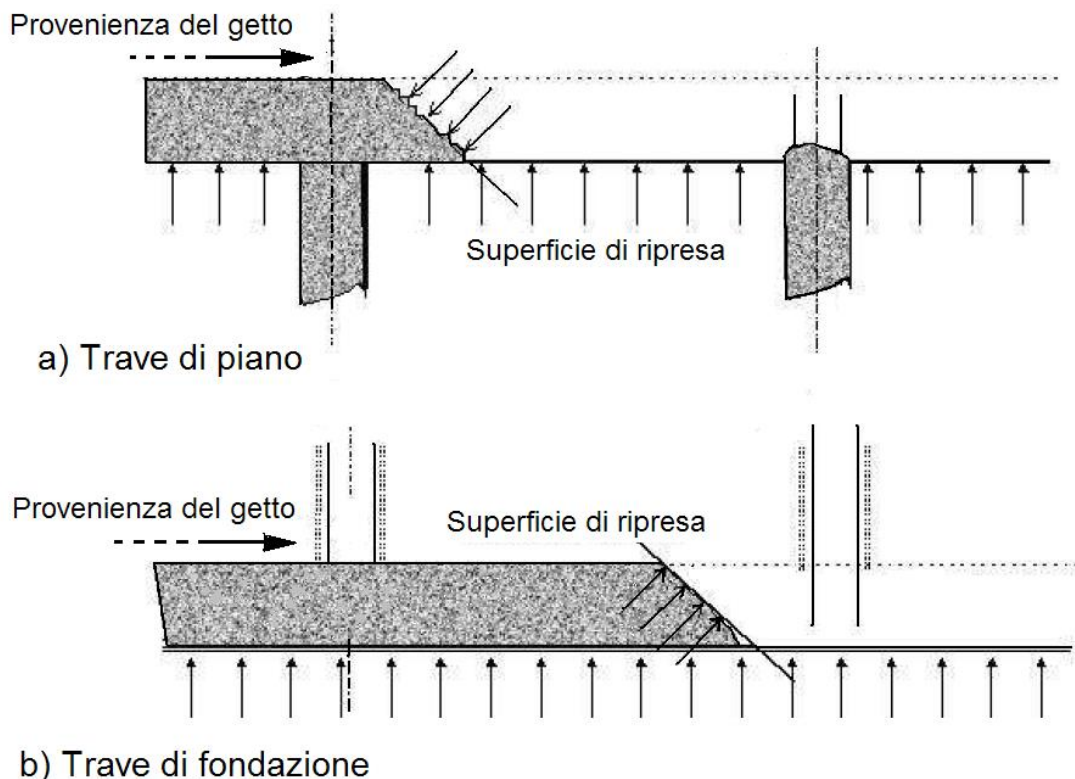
Modalità di ripresa del getto in travi di piano e di fondazione
